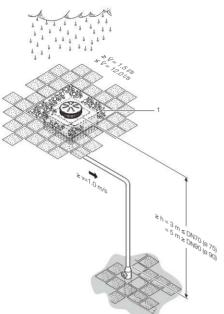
Exigences minimales pour le système d'évacuation des eaux pluviales Geberit Pluvia lors d'une toiture plate
